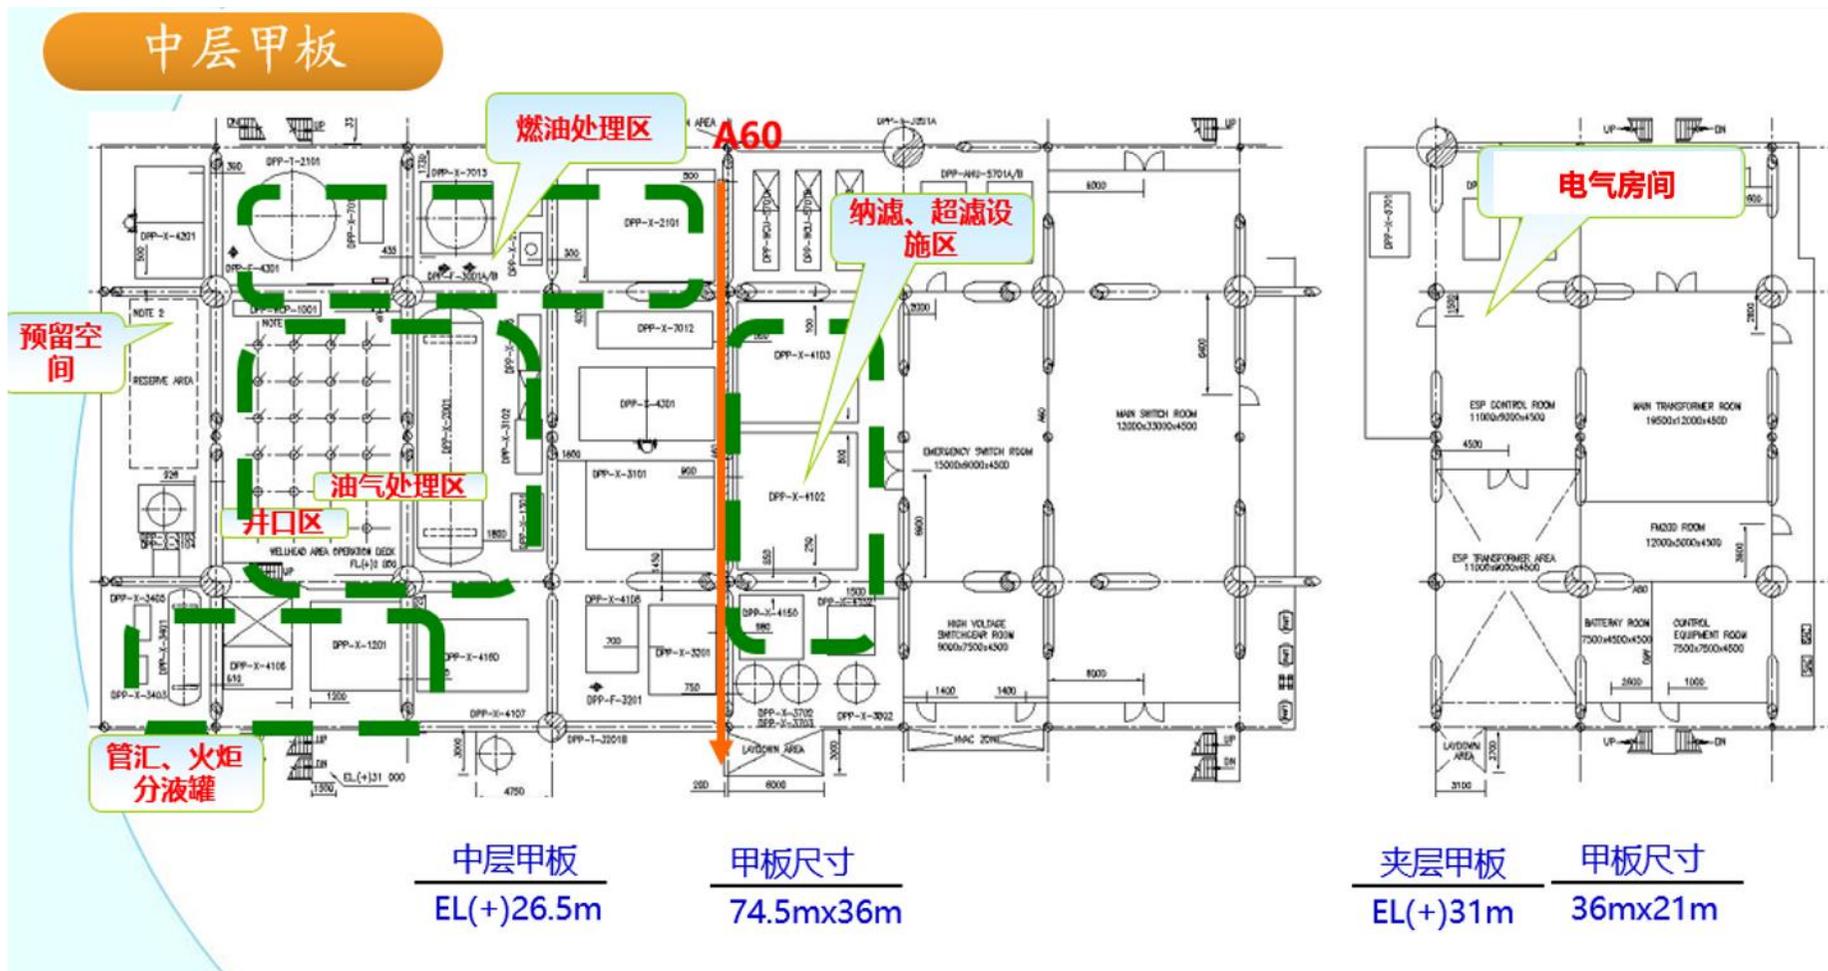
新建 LF14-4 DPP 平台中层甲板平面布置图
